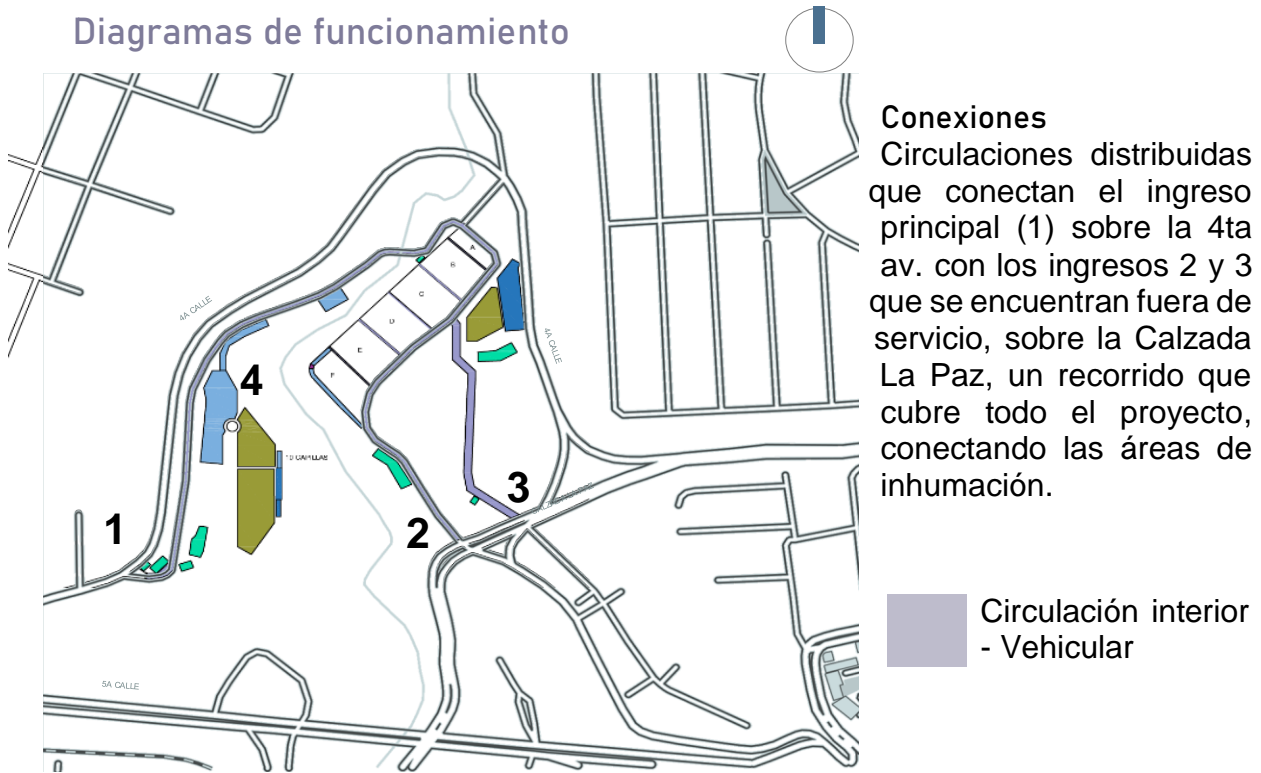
Planta de circulaciones e ingresos al cementerio. Fuente: elaboración propia
